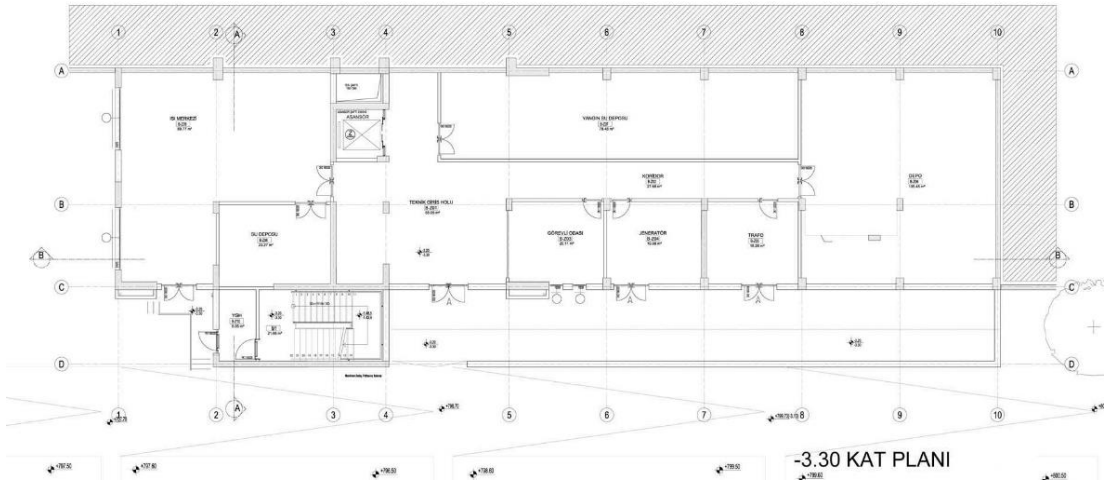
Bozüyük istasyonu B blok zemin kat planı ve vaziyet planı (İtez, 2015)
